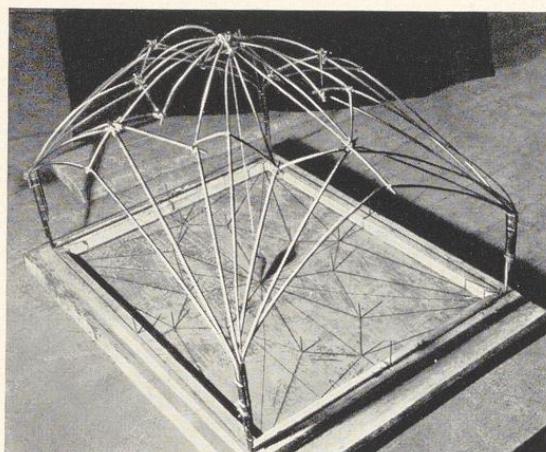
Sternengewölbe über rechteckigem Grundriss. Die Grundform bildet ein Spitzbogen-Kreuzgewölbe mit ansteigendem Bogenscheitel
